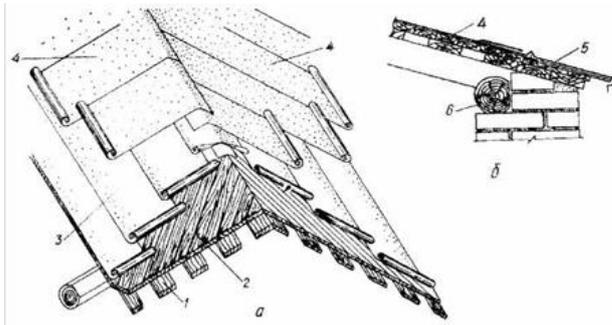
Кровля из рулонных гидроизоляционных материалов: а – общий вид; б – карнизная часть; 1 – рабочий слой; 2 – защитный слой; 3 – пергамин; 4 – рубероид; 5 – кровельная сталь; 6 – мауэрлат.
